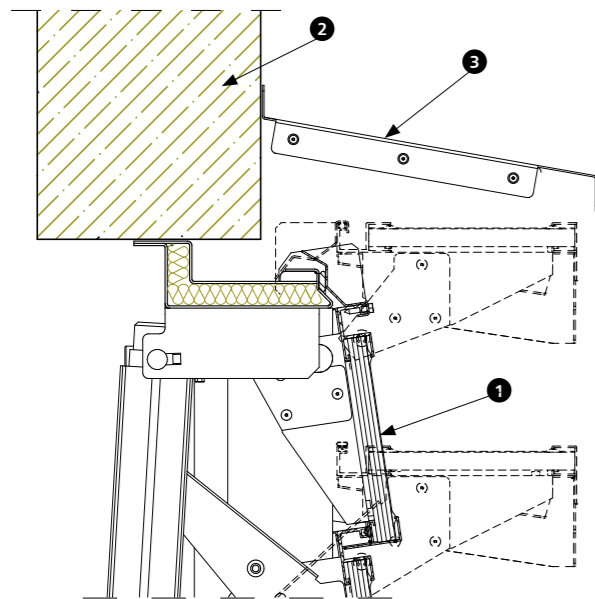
Montage des Lamellenlüfters direkt in Maueröffnung (Wand, Fassade)
